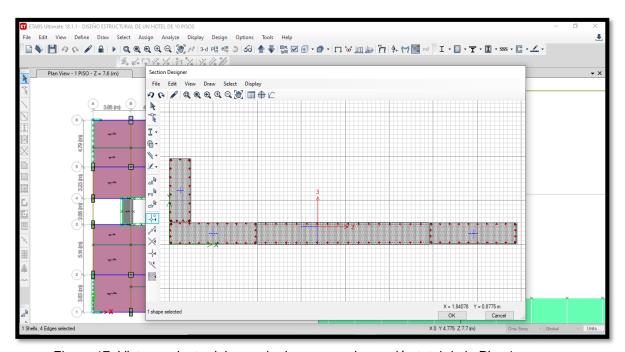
Vista en planta del armado de acero en la sección total de la PL - 1.
